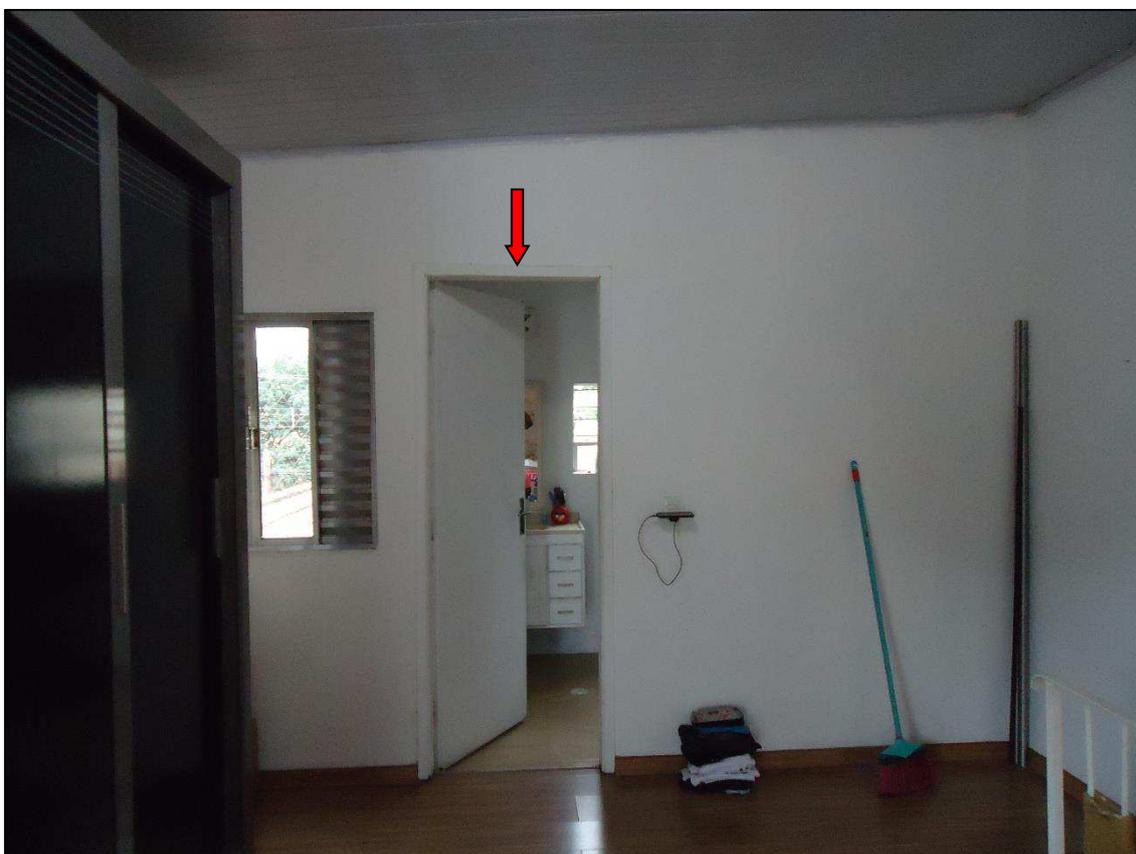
Vista parcial do dormitório no pavimento superior destacado porta de acesso ao banheiro.
